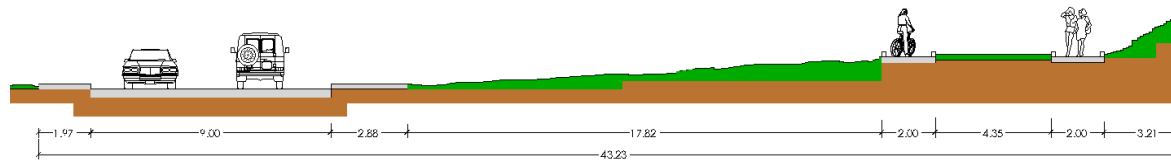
Sección transversal Avenida 24 de Mayo (1)
